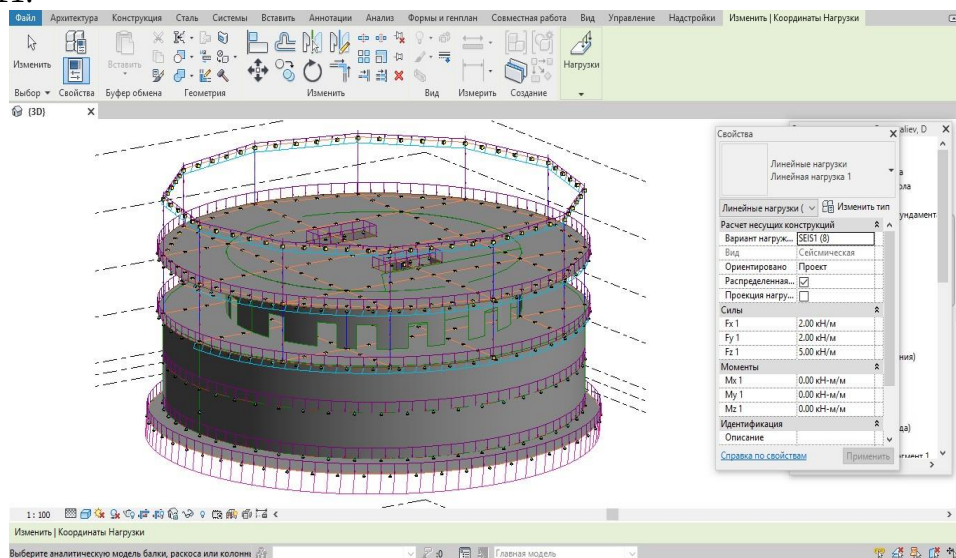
Расчетное сочетание нагрузок в среде Revit
